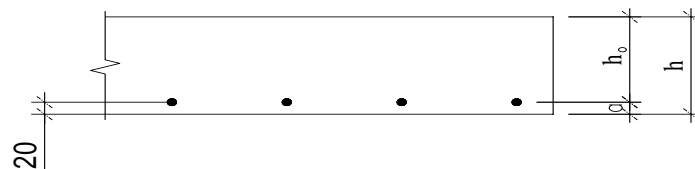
Поперечний переріз перекриття для плити П-1.
